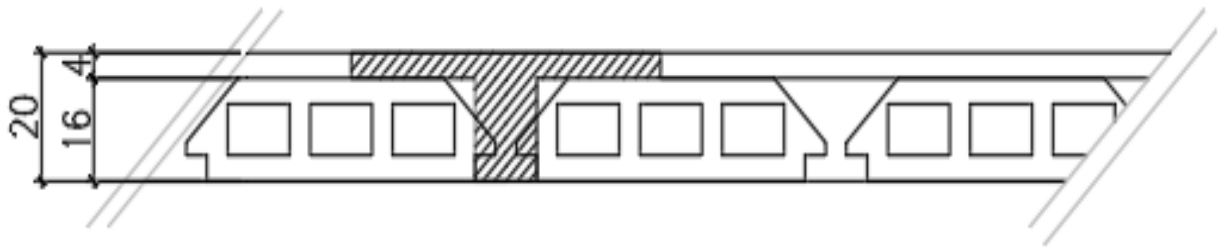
schéma réel d'un plancher a corps creux.
